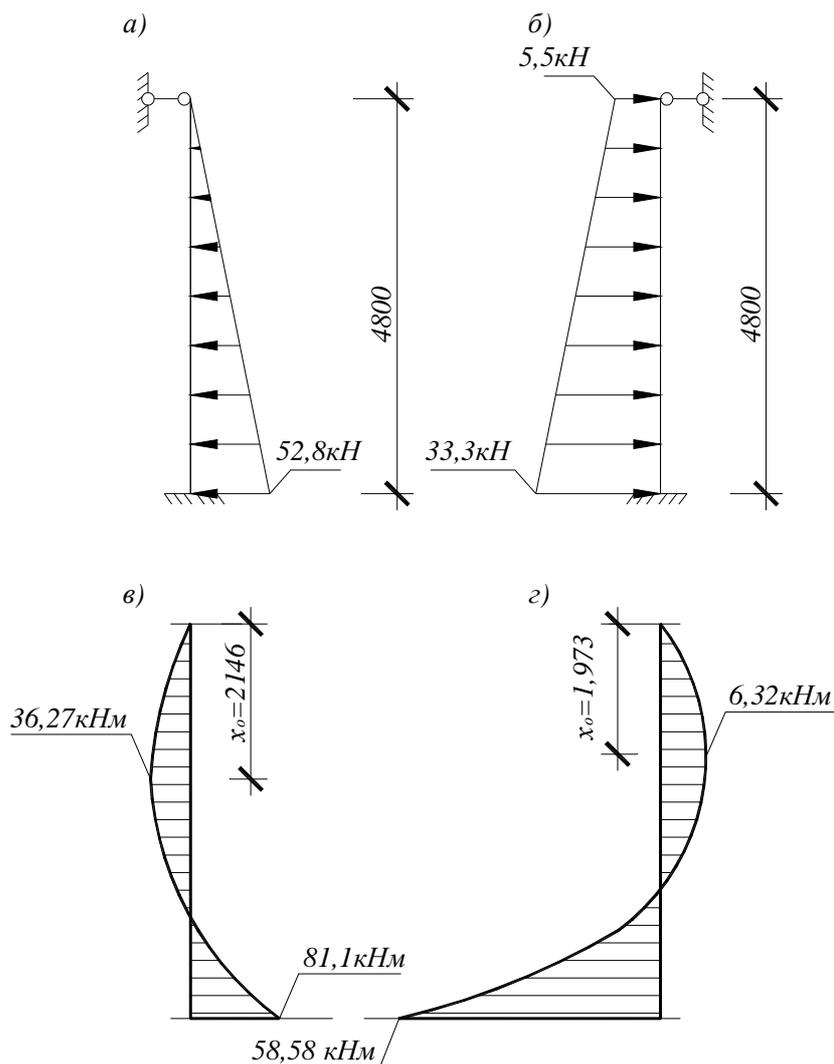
Расчетные схемы и эпюры моментов в стенке резервуара:
